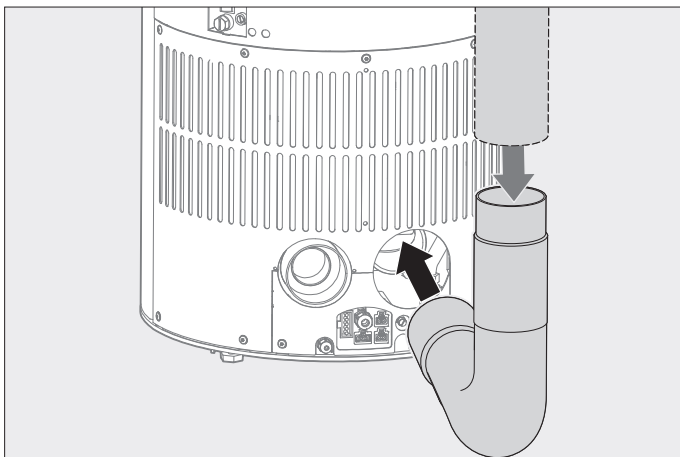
Placer la tubulure d'échappement sur le raccord (sur site)
